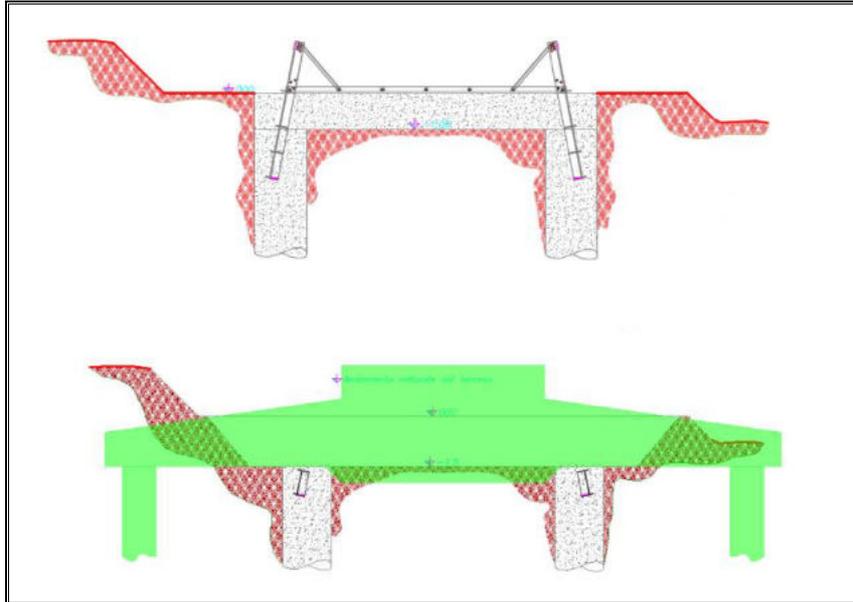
Schema tipico di alloggiamento della nuova fondazione (colore verde) su fondazione esistente e parzialmente demolita (colore grigio).
